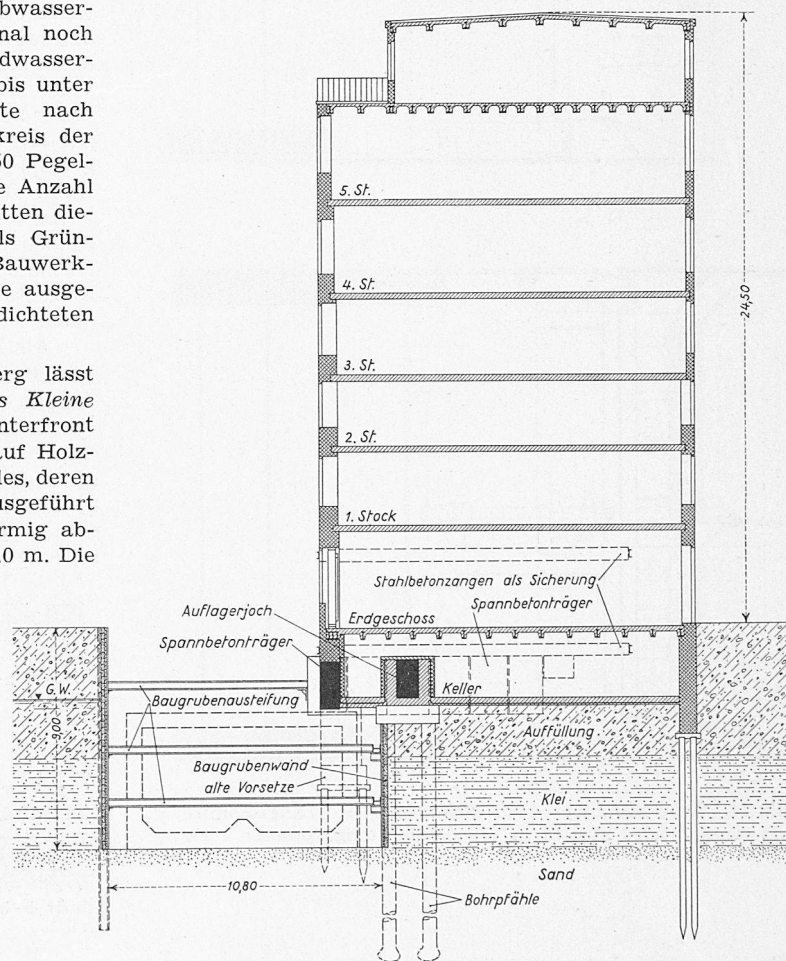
Baugrube im Bereich des Hauses Kleine Reichenstrasse 3, Schnitt 1:300
